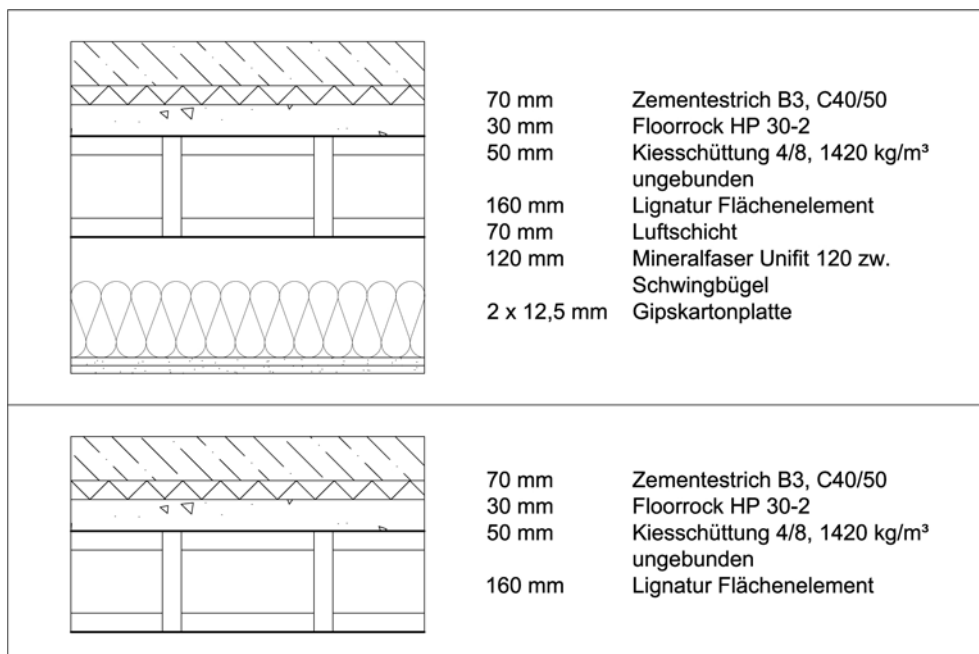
Geprüfte Deckenkonstruktionen Lignatur Flächenelement 160 mm mit und ohne Unterdecke
